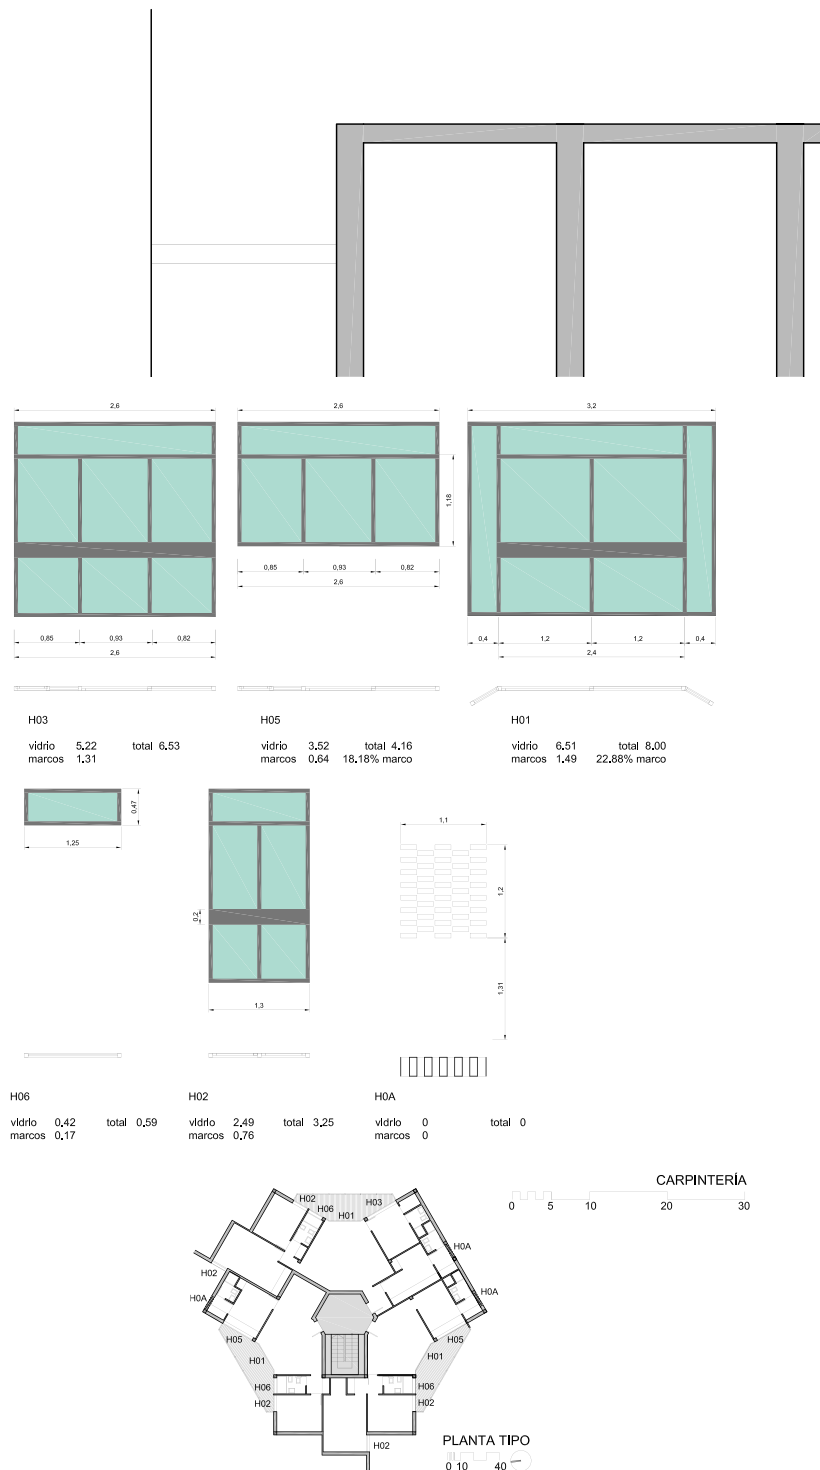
Arriba. Sección de un módulo hexagonal del basamento. Abajo plano de carpintería. Elaboración propia en base a los planos de proyecto y la inspección del edificio contruido.
